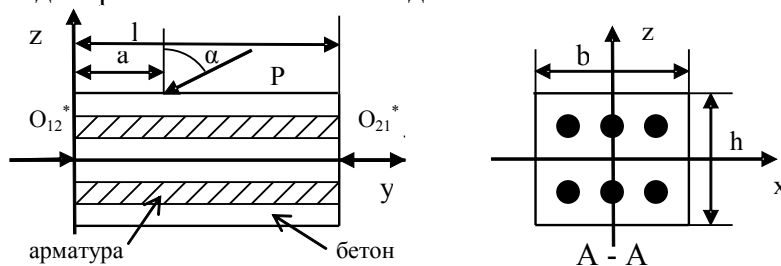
Сжатый железобетонный элемент под действием сосредоточенной нагрузки.
